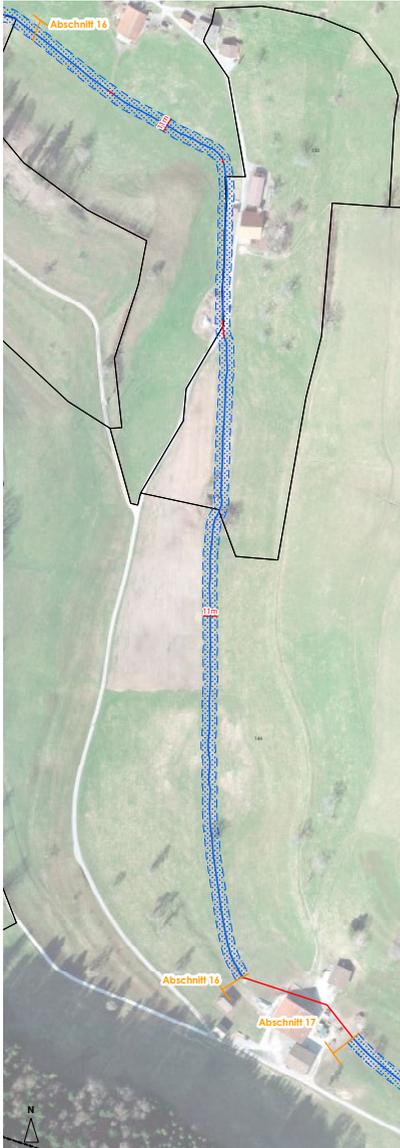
Detailplan Sarbach, Abschnitte 16 bis 17
